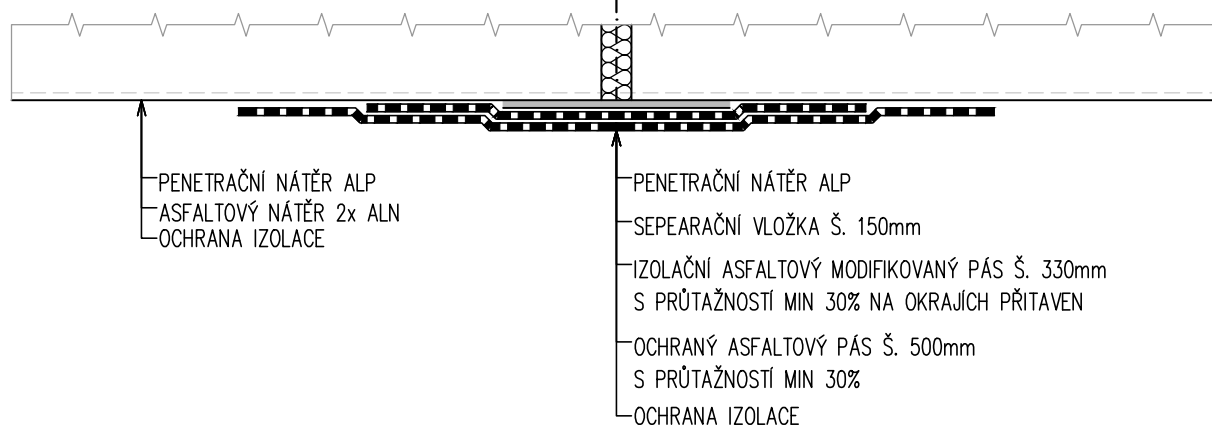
DETAIL PRACOVNÍ SPÁRY – RUB 1:5
